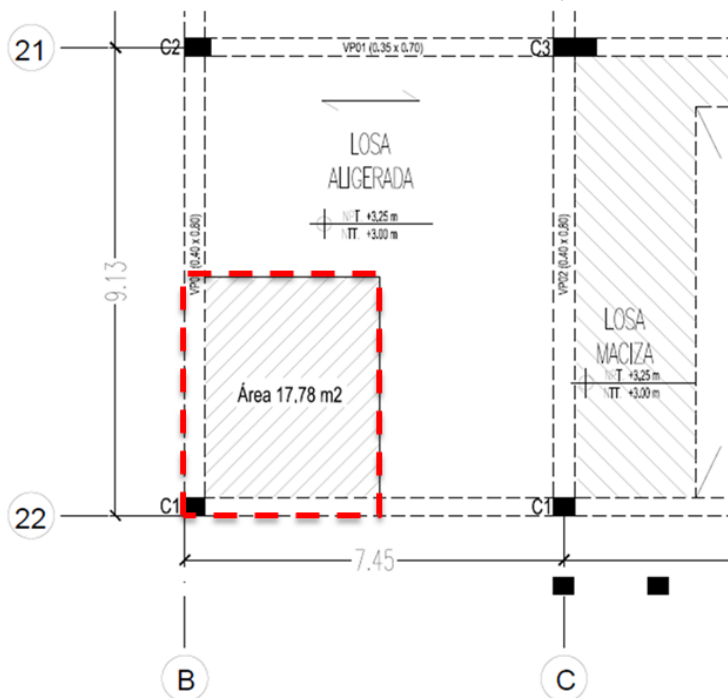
Área de influencia de columna C-1, en los pisos 1, 2 y 3
